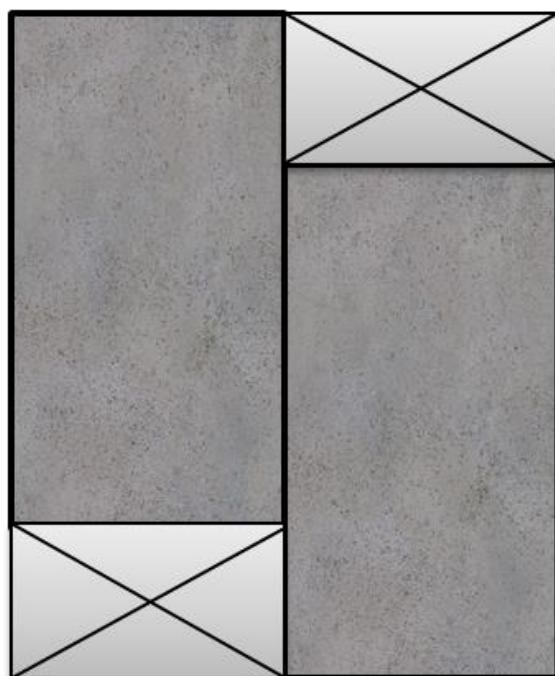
Croqui mostrando o formato da planta baixa das edificações e os vazios externamente.
